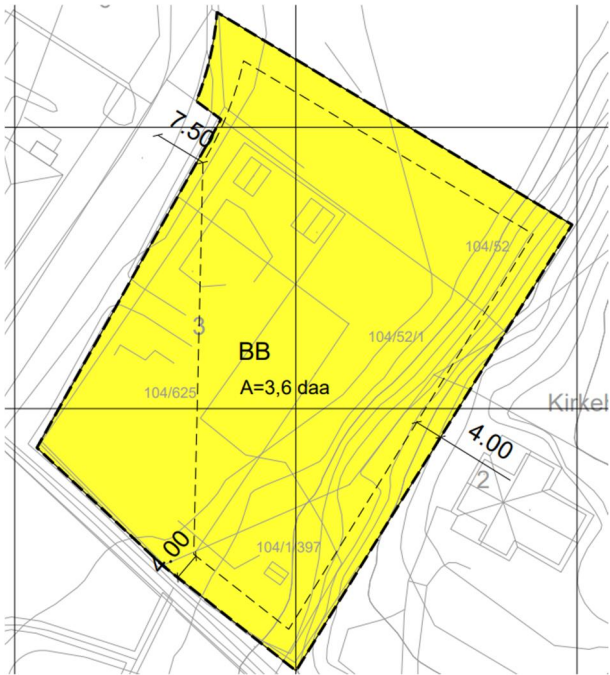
Situasjonsplan barnehagetomt med snittplassering
